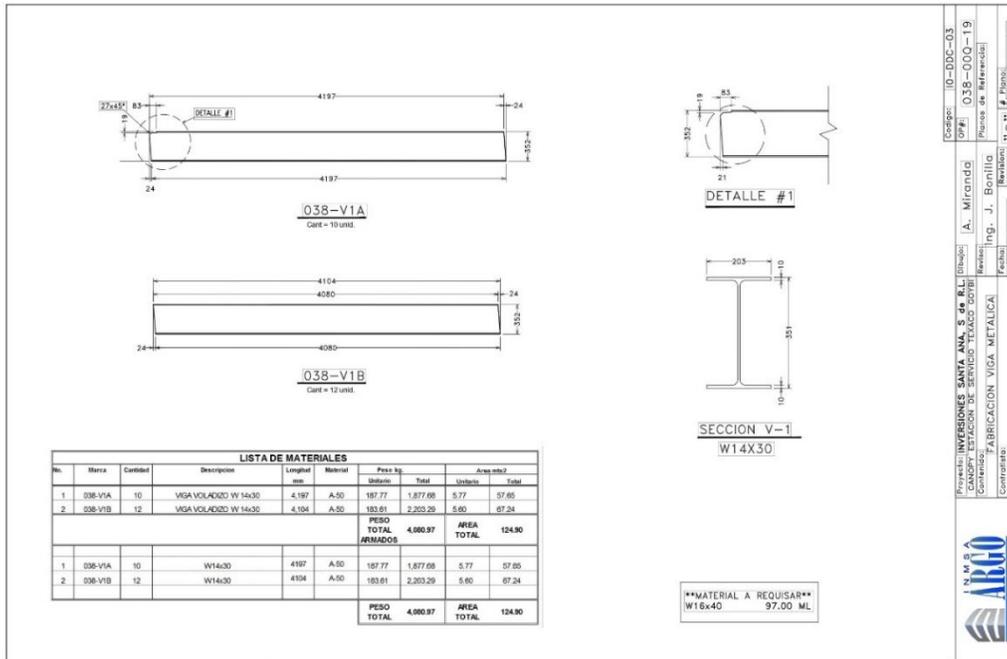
Plano de fabricación de vigas metálicas, canopy mayor
